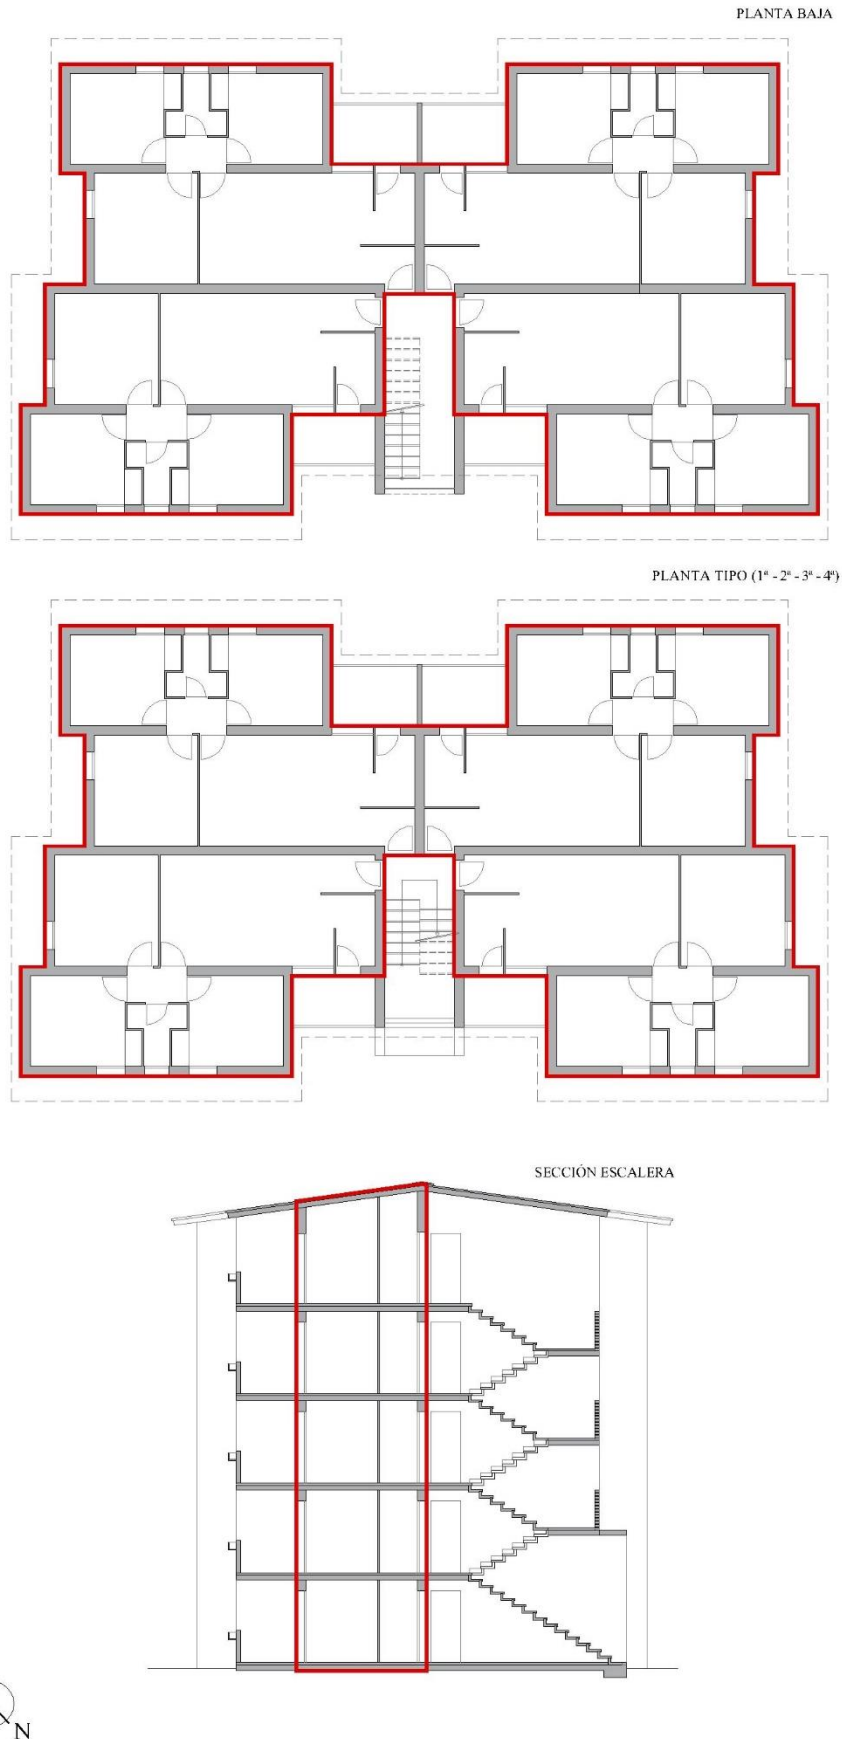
Planimetría EO de la envolvente térmica. Fuente: Elaboración propia.
